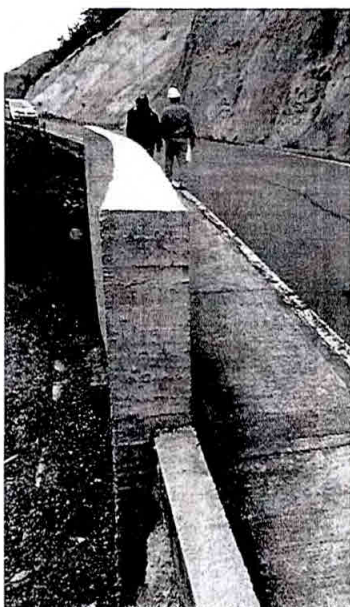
Muro en concreto reforzado y cunetas en buen estado
